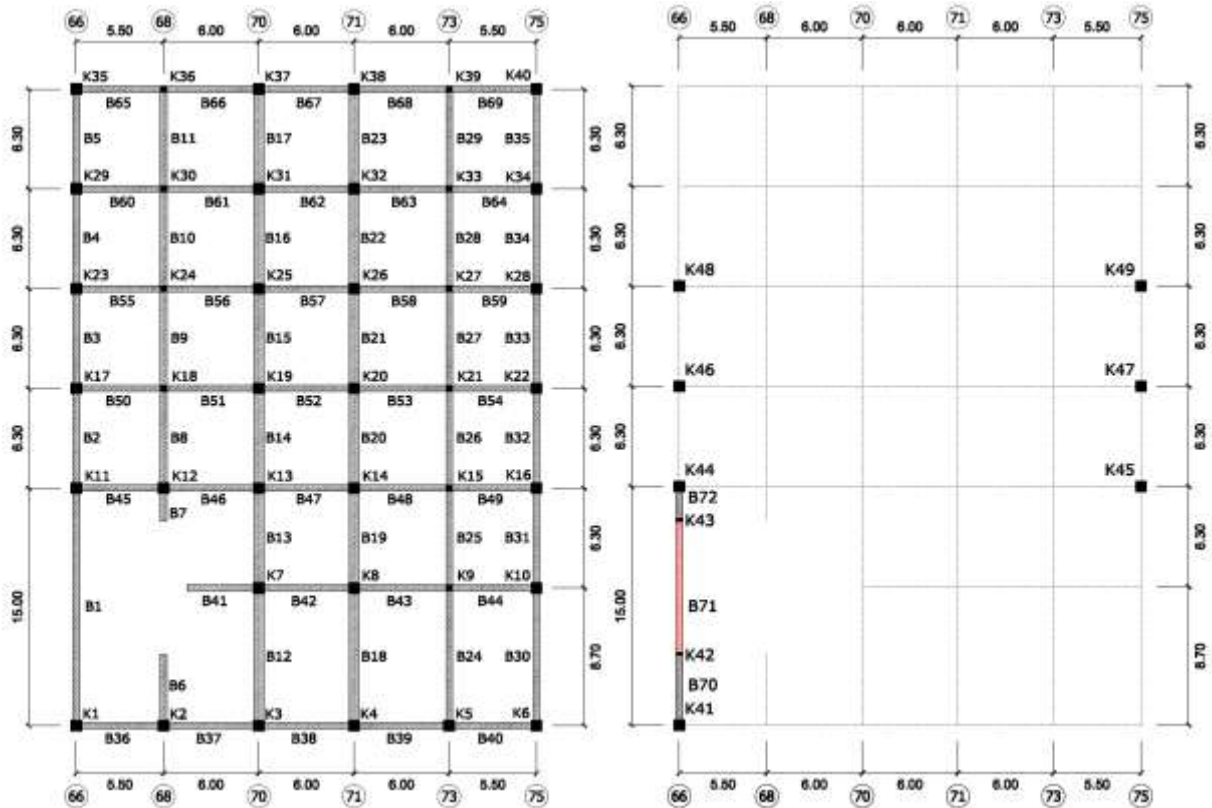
Lokasi Balok dan kolom Terminal 1B VIP (Area : Breakdown)
